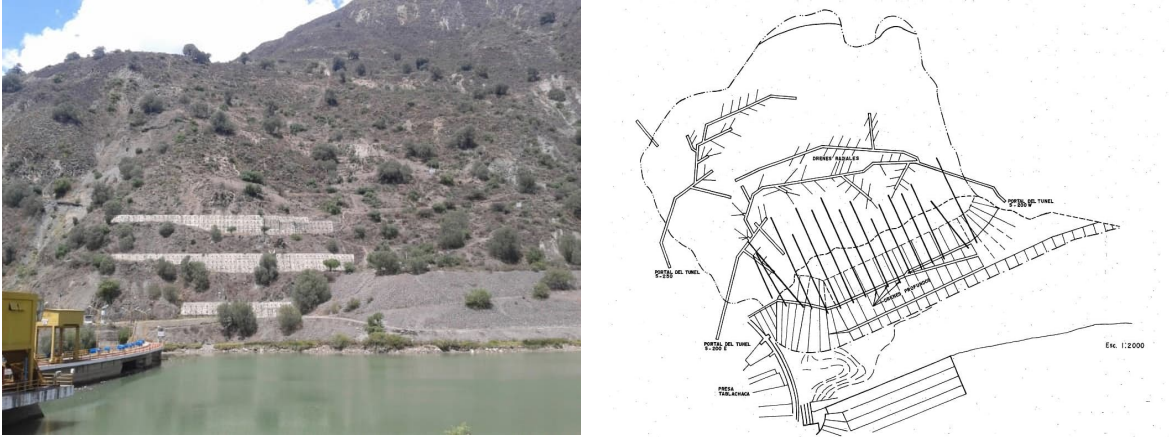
Vista frontal del Derrumbe N°5, ubicado sobre el estribo derecho de la presa de Tablachaca y Planta del sistema de túneles y drenaje subterráneo (Fuente: Proyecto 1982-1984)
